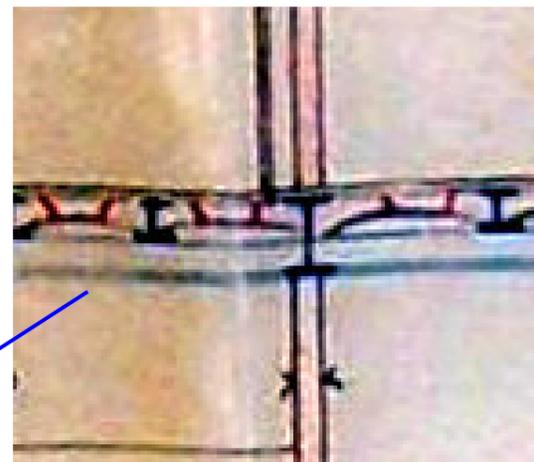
Cortes do projeto do prédio de nº 177 da Avenida, projeto de Lourenço Lavignino, para a Santa Casa de Misericórdia; vista parcial da fachada no nível do pavimento térreo, contendo detalhe de fixação de dois perfis I para sustentação do vão central, de maior dimensão, transferindo para as laterais da porta os esforços e cargas atuantes na região acima da abertura.
